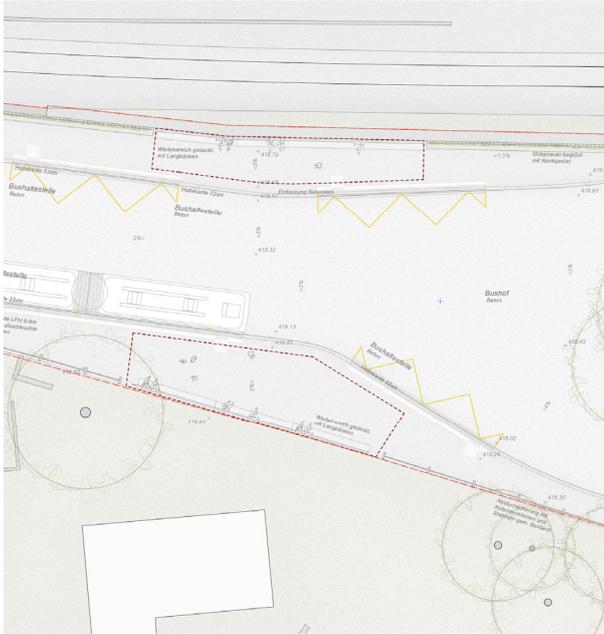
Planausschnitt der Wartebereiche mit Langbänken und Haltestellenüberdachungen.
